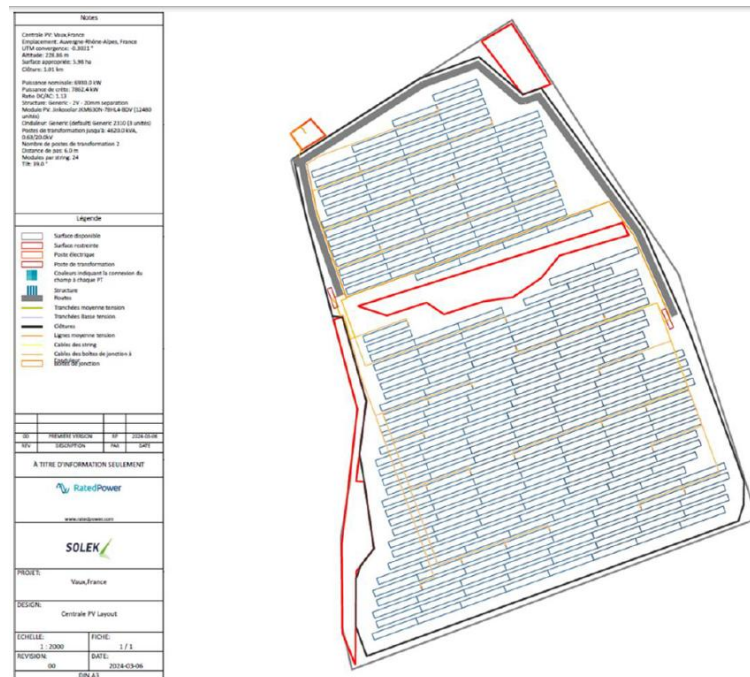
Plan d'installation du parc photovoltaïque de Vaux, Solek
